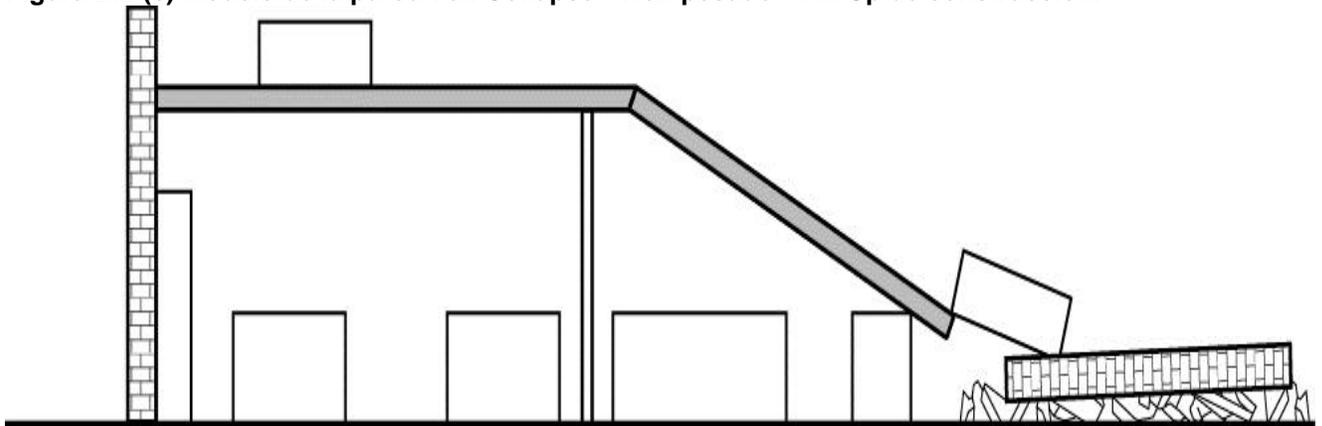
(d) Patrón Pancake Collapse - Pesado Floor construcción.
